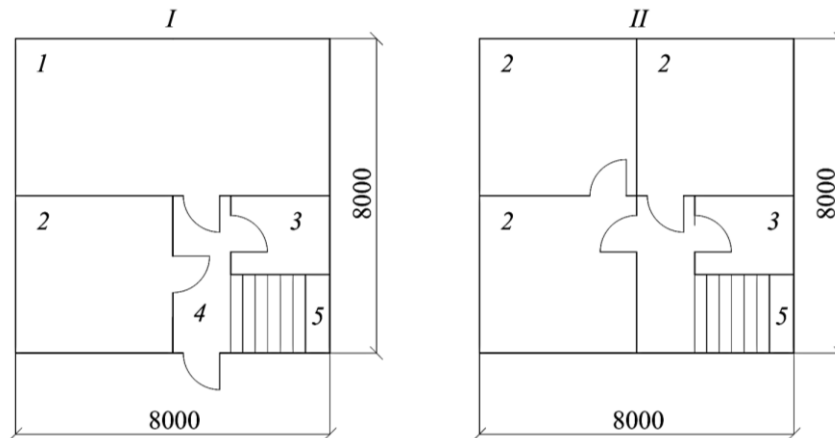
План-схема одноквартирного жилого дома: 1 – кухня-гостиная; 2 – жилая комната (спальня); 3 – совмещенный санузел; 4 – коридор; 5 – лестничный марш; I – первый этаж; II – второй этаж
